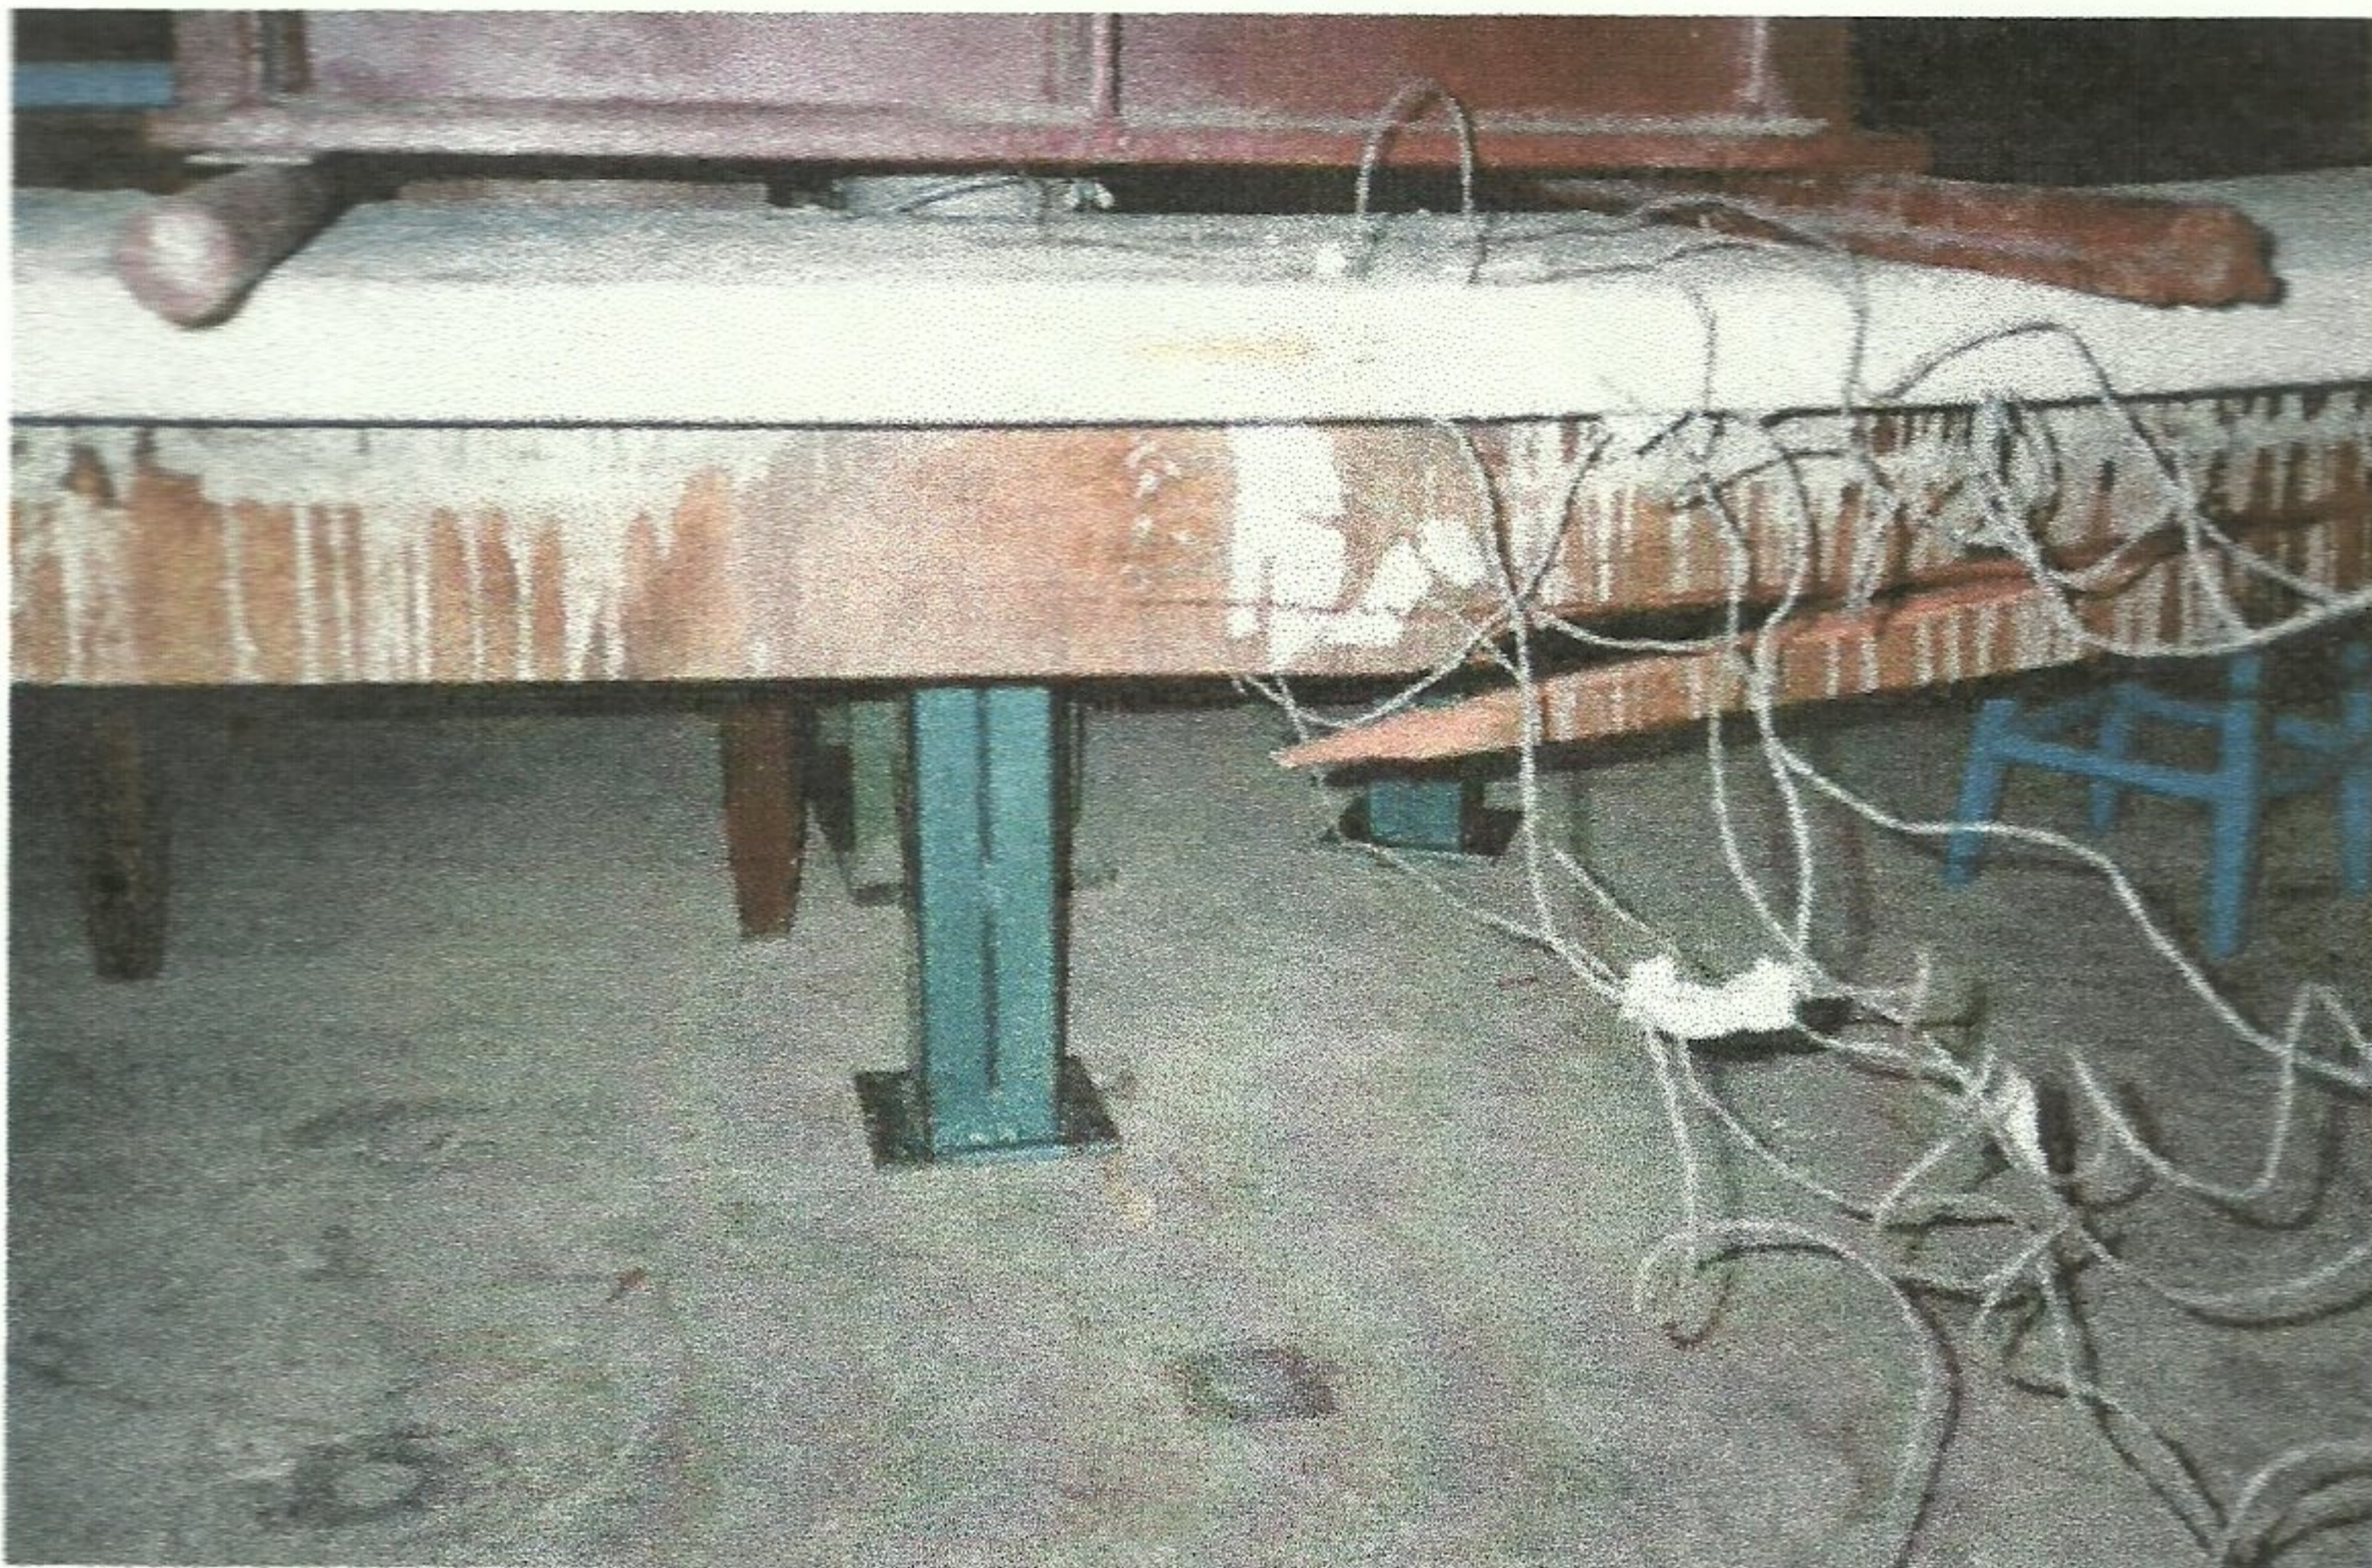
Região Central da Viga Composta e Extensômetros Detalhe da Ruptura
